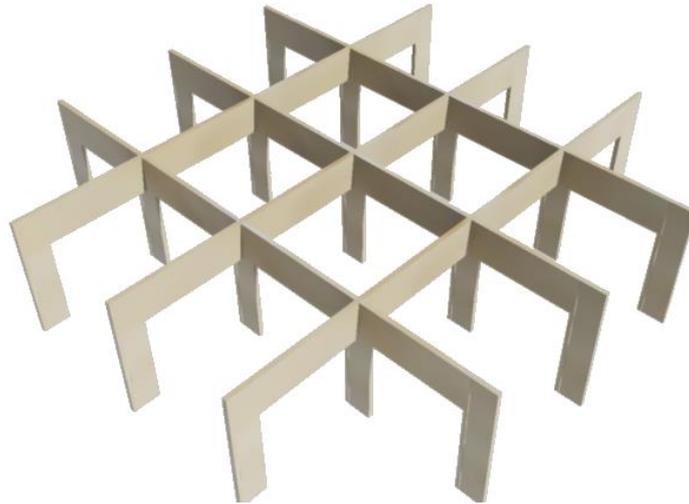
Esquema de Disposição dos Pilares em MLCC
